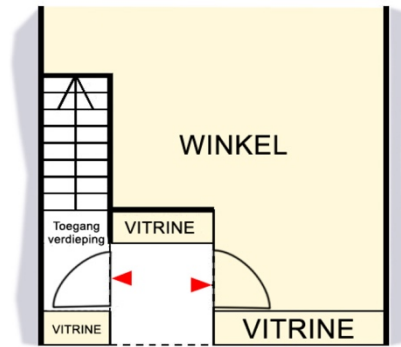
Principetekening afzonderlijke ingangen (Gewestelijke Overheidsdienst Brussel)
